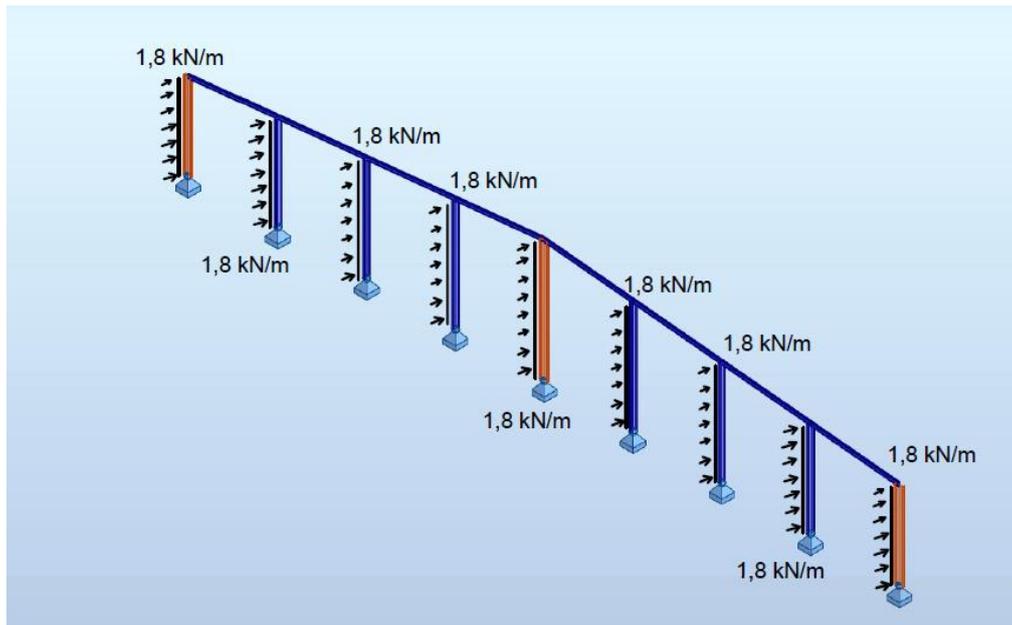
REPRESENTACIÓN DEL PÓRTICO DE FACHADA (PLANO PERPENDICULAR AL PÓRTICO) EN ZONA D PARA CARGAS CON DIRECCIÓN LONGITUDINAL A LA FACHADA
